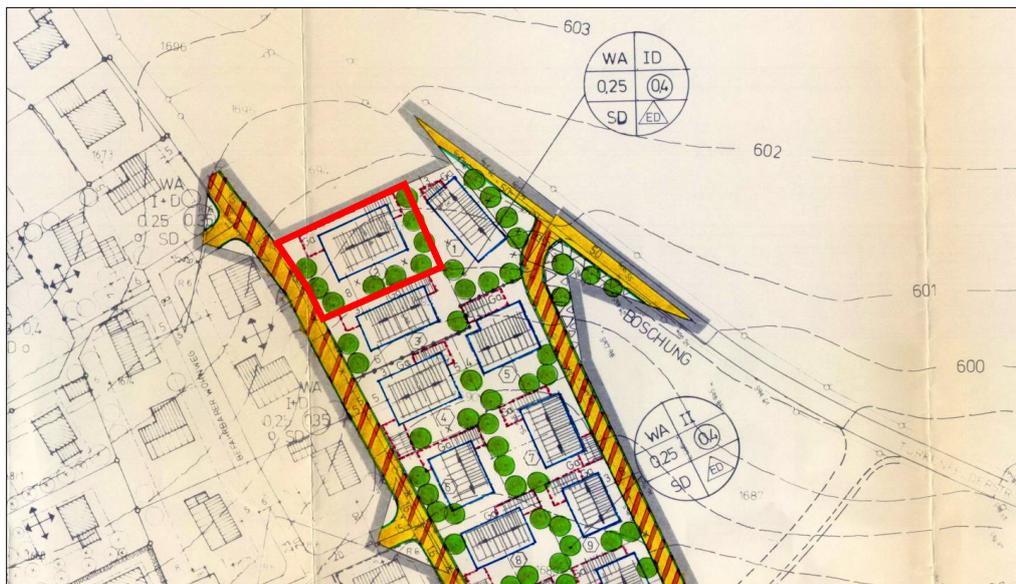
Auszug rechtsverbindlicher BP „Geltendorf - Schulstraße III“ mit Änderungsbereich
